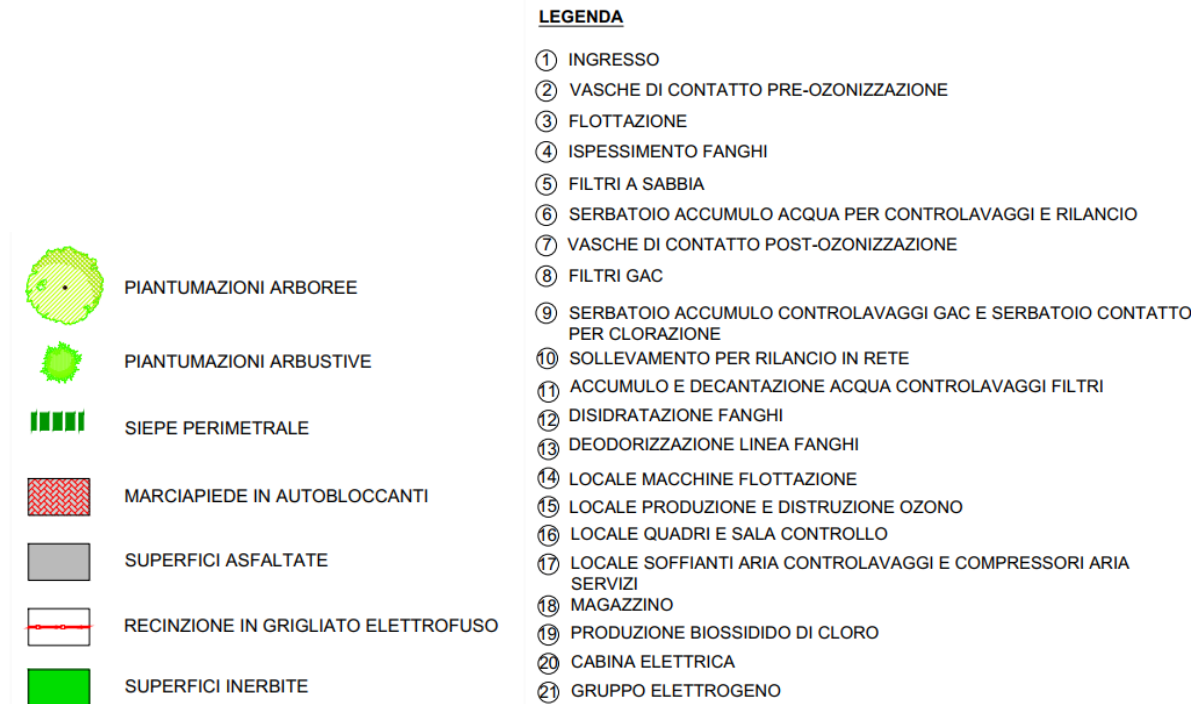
Impianto di potabilizzazione – pianta (legenda)
